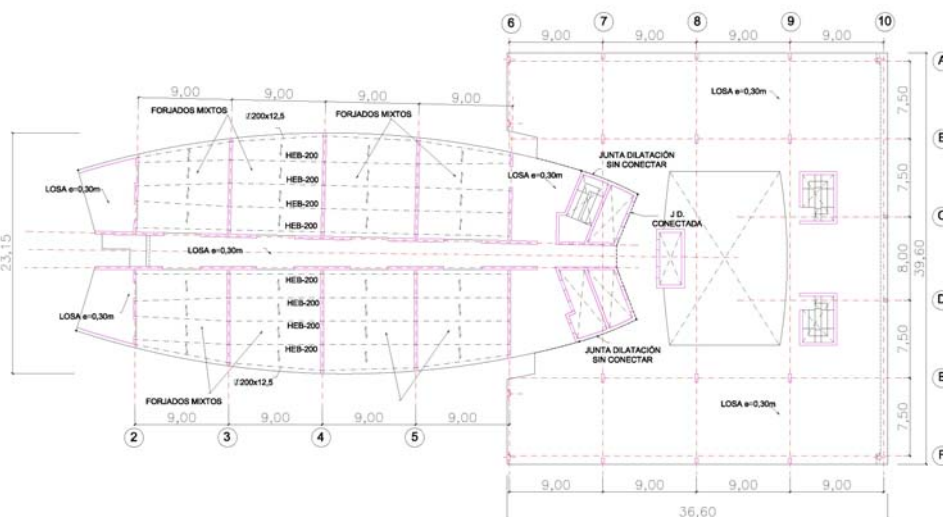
Planta tipo entre P-1 y P-7 con los edificios Torre y Atrio del Hotel Vela
